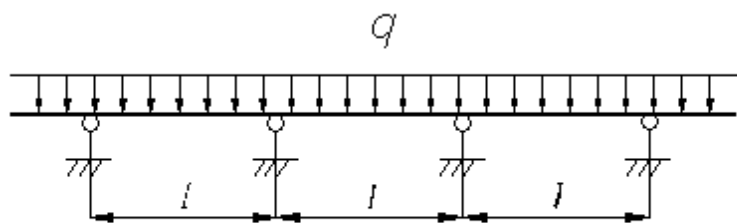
Расчетная схема трубопровода q – собственный вес трубопровода, изоляции и нефтепродукта; l – расстояние между опор.
